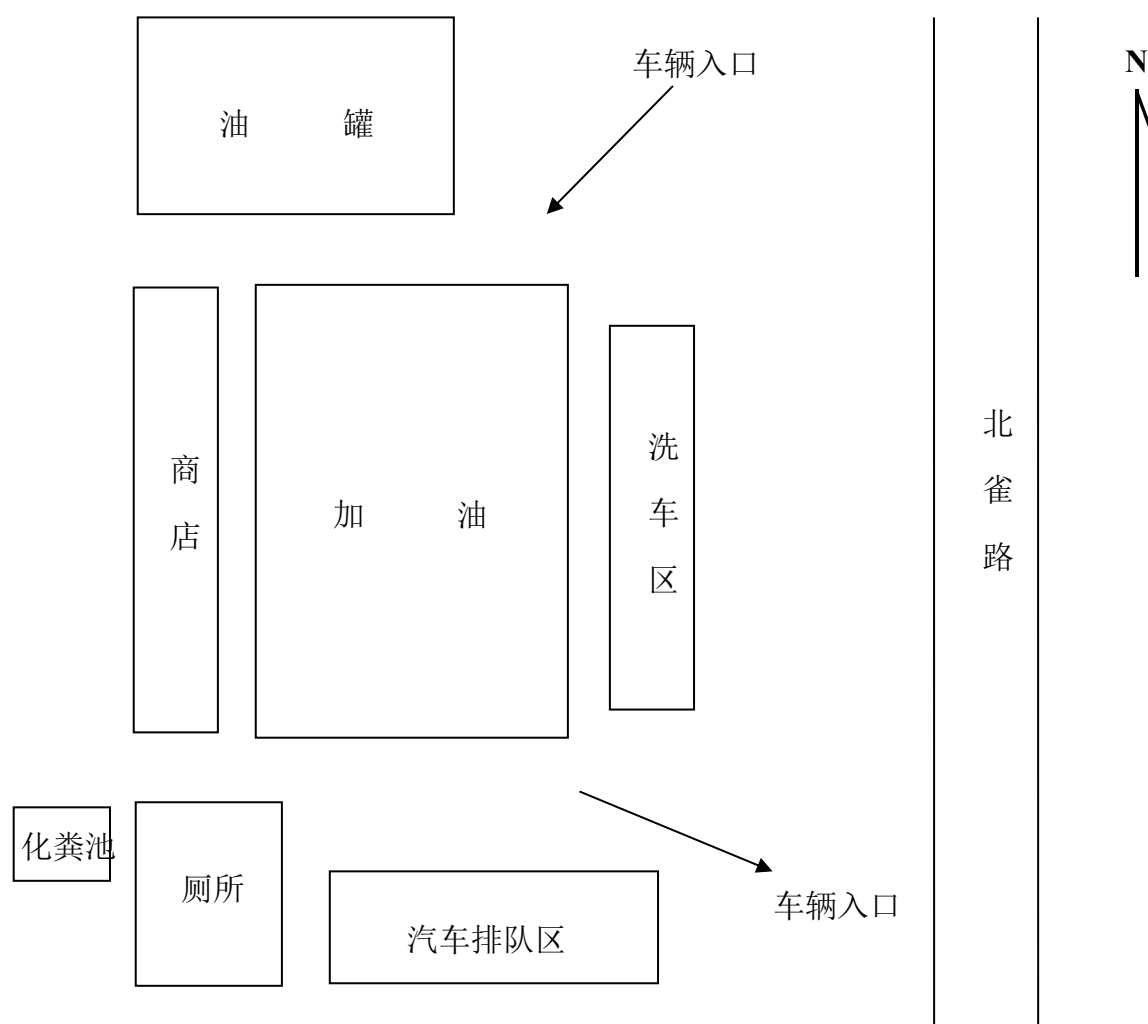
中国石油柳北柳鹊加油站网点平面布置图
